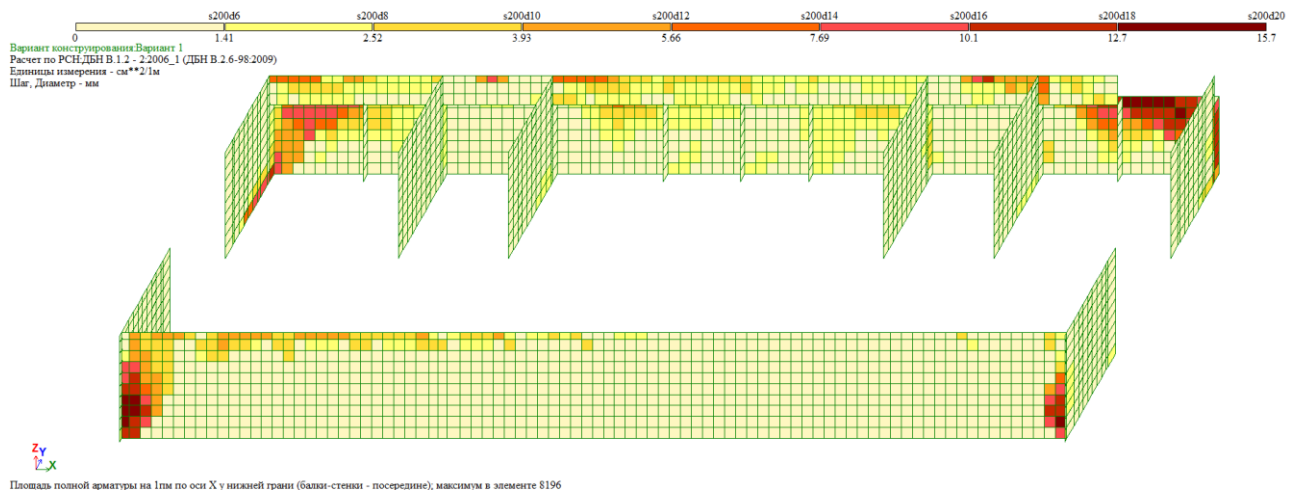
Розрахункове армування нижньої грані стін підвального поверху
